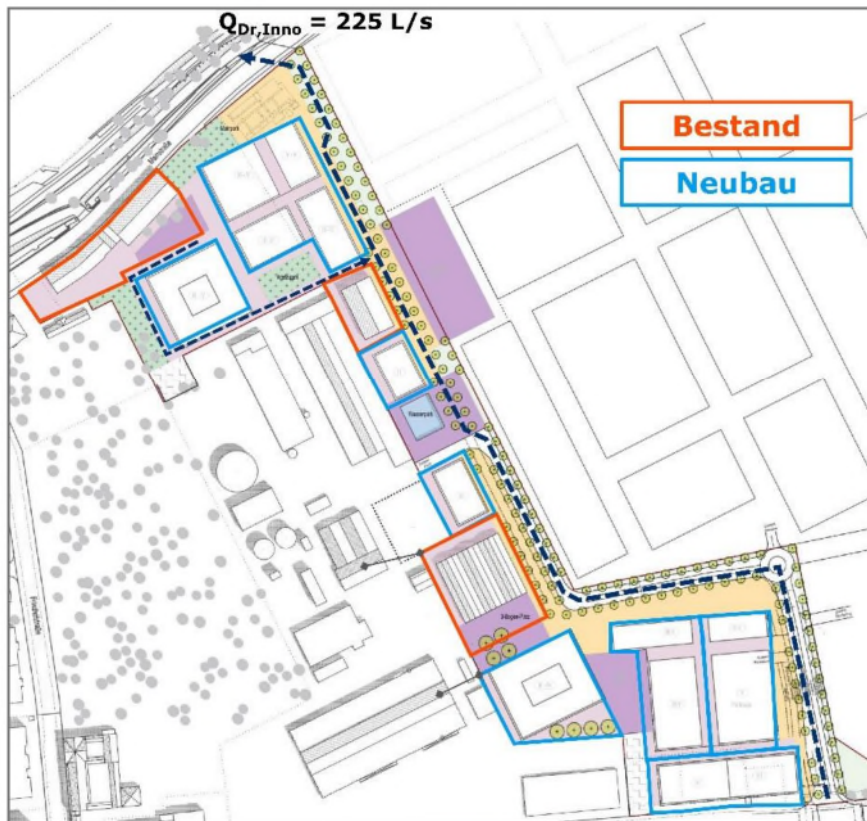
Grundstücke mit Bestandsgebäuden am Innovationsband
